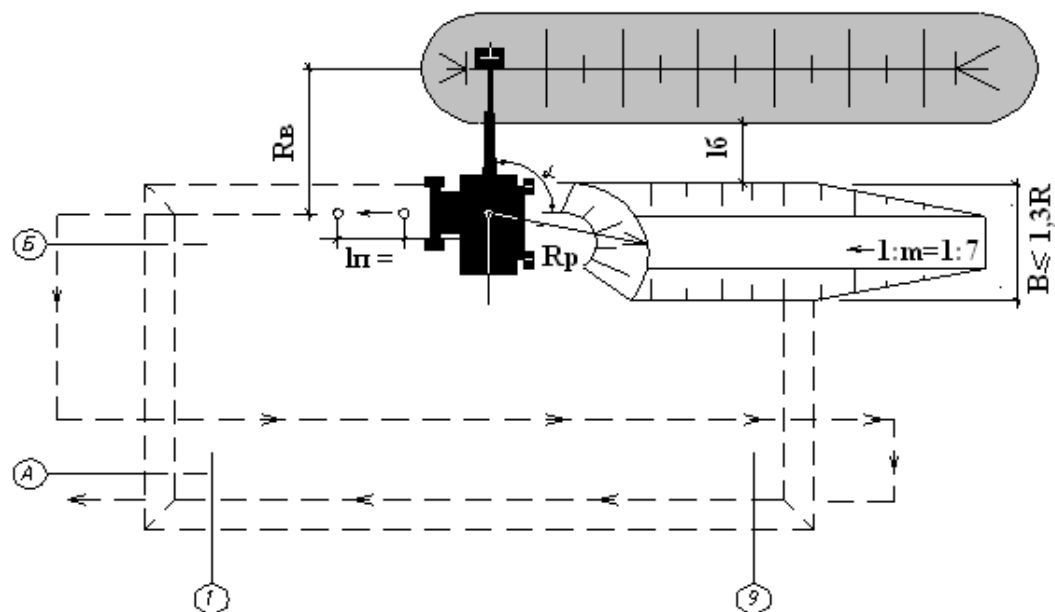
Схема лобовой проходки при устройстве котлованов с разработкой грунта навывмет
